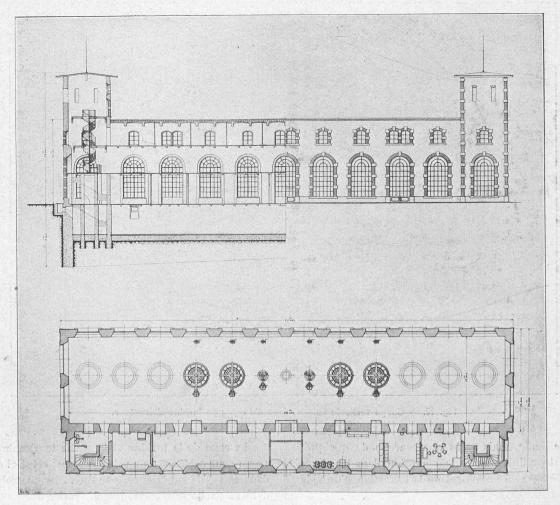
Plan et coupe de l'usine. — Echelle : 1 : 500.
